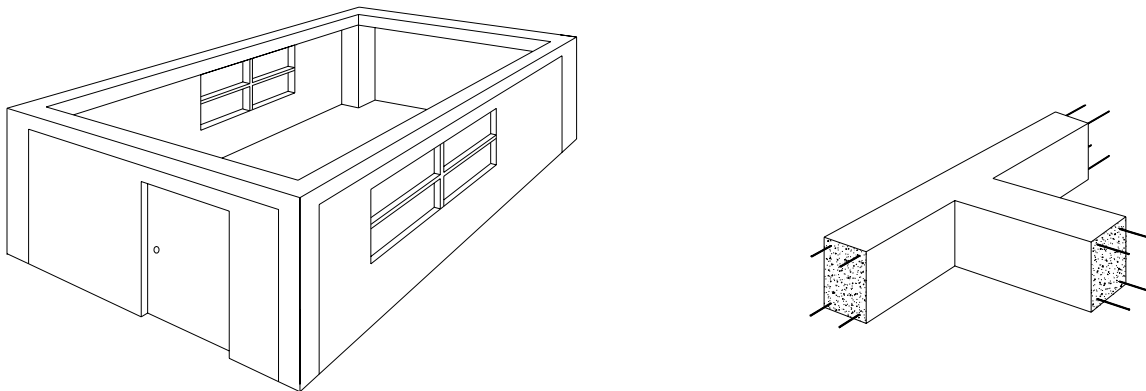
MUROS REFORZADOS CON VIGAS Y COLUMNAS DE Ho.Ao.
